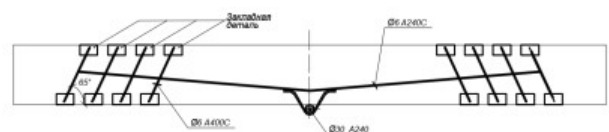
Схема підсилення балки БПП-II-1 поздовжньою і поперечною паралельно розташованою зовнішньою арматурою
